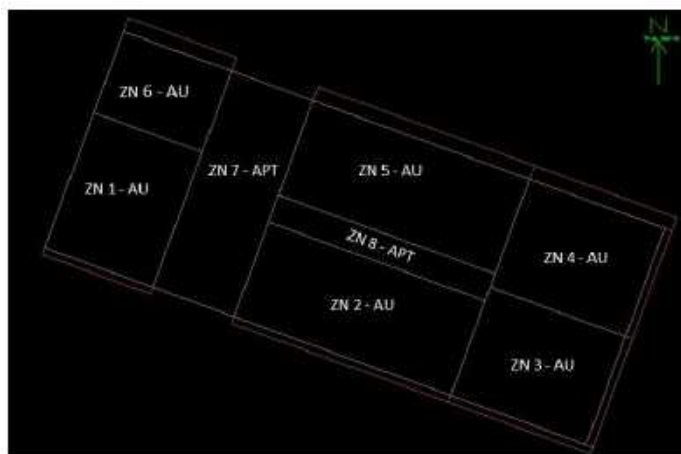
Divisões das zonas térmicas do pavimento tipo
